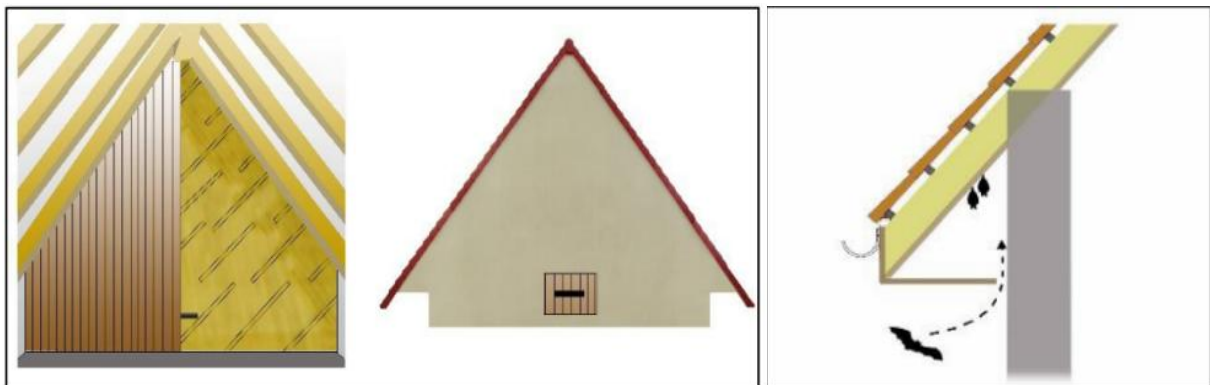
Bardage de la paroi intérieure avec accès direct depuis l'extérieur de la même façade (Source : Cerema Est) et exemple de nichoir intégré ou construit au niveau de la toiture ou du débord de toit
